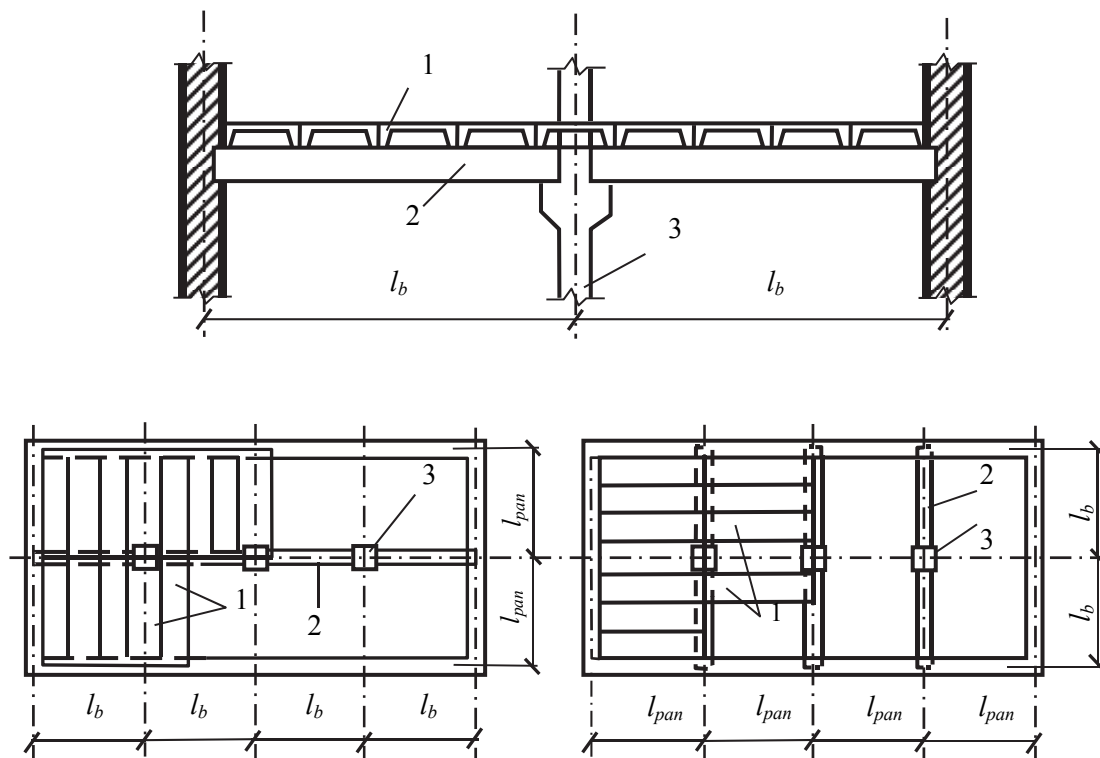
Конструктивные схемы сборных балочных перекрытий:
